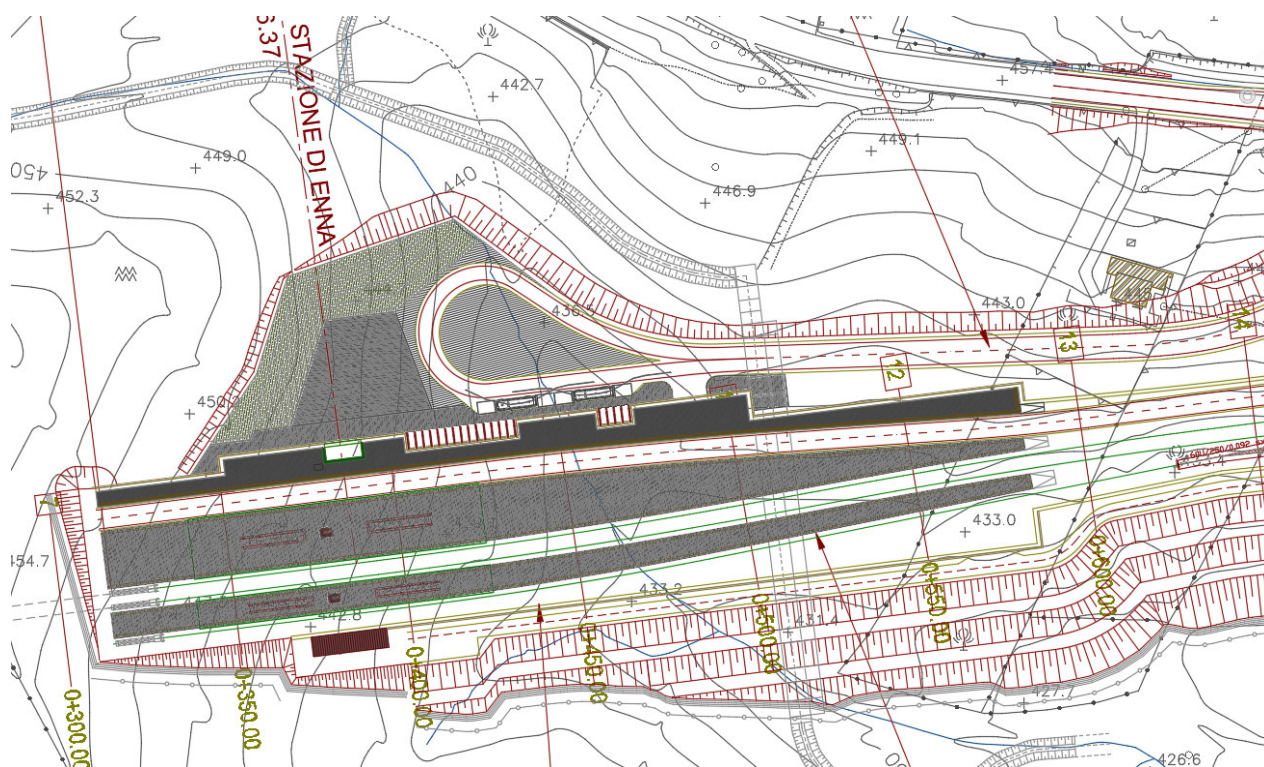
Pianta quota banchina stazione di Enna (Rif.)
